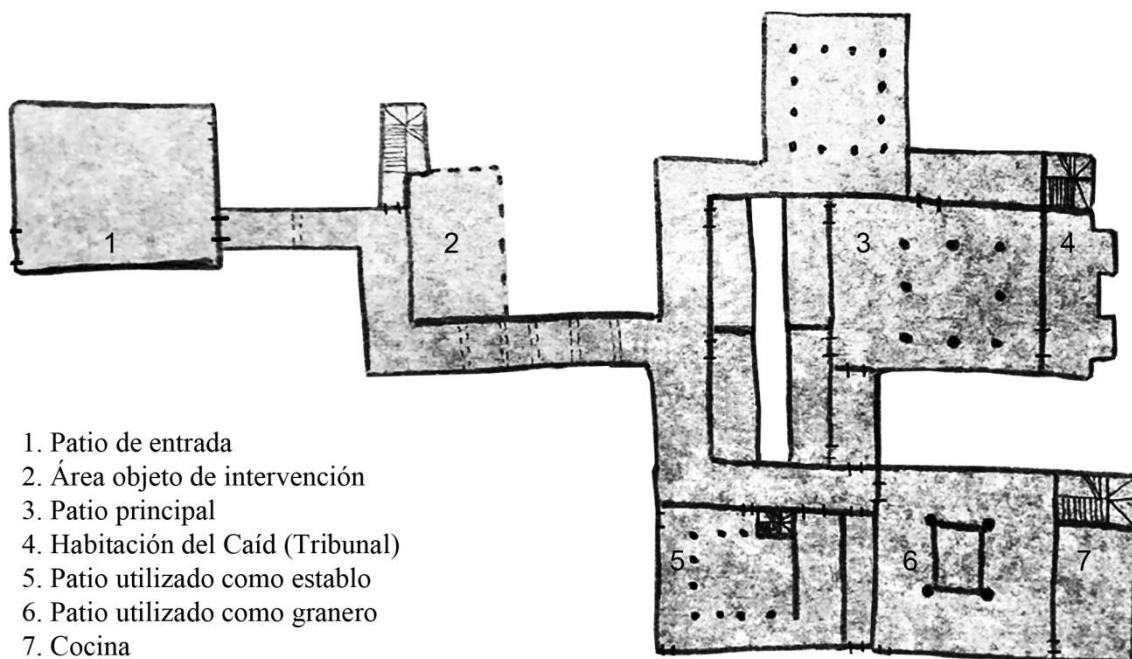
Planta baja de la *Kasbah des Caid*. Elaboración propia
